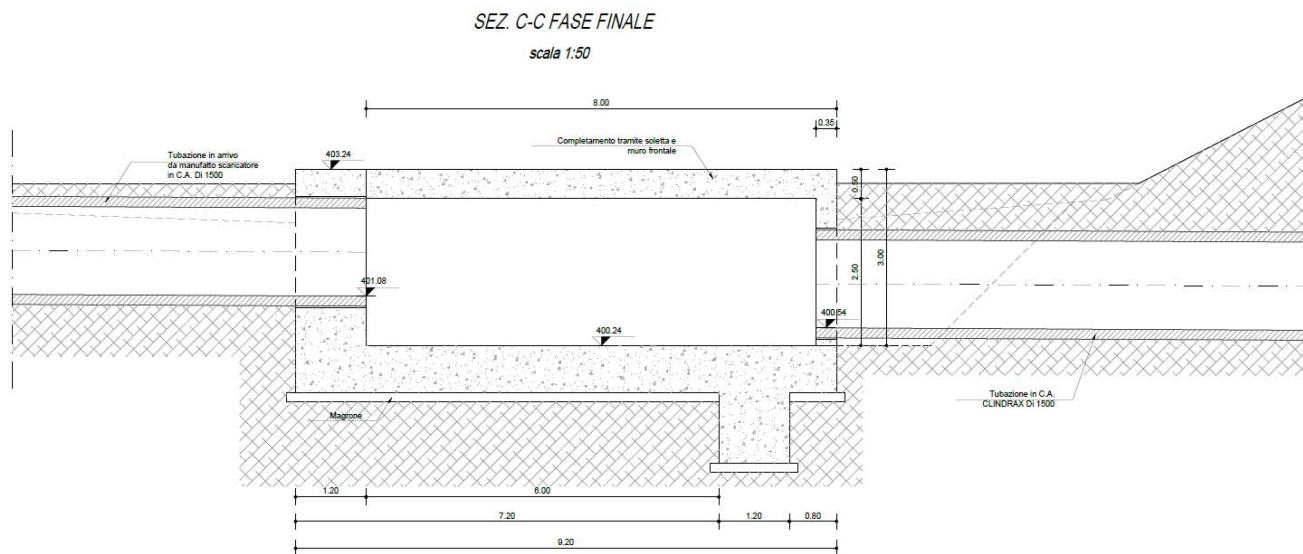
Sezione longitudinale del pozzetto spingitubo in fase finale
